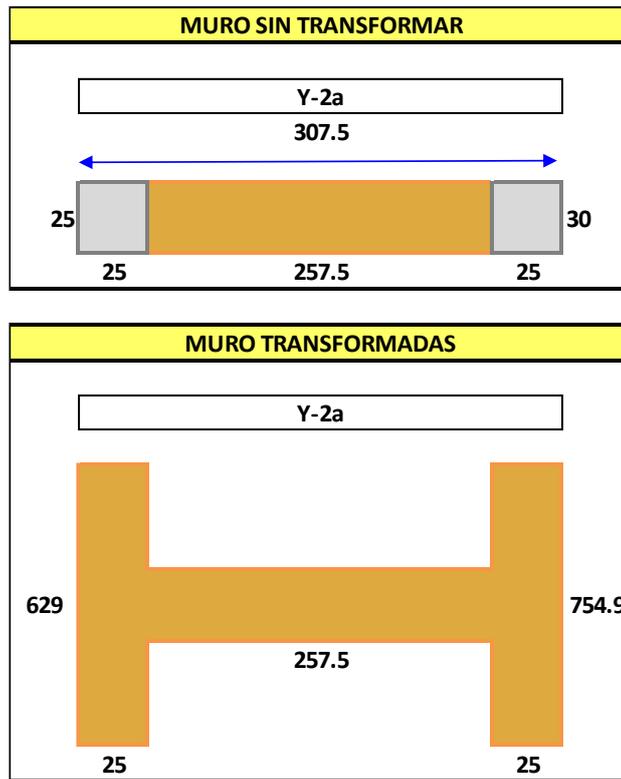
Fig. 68. Sección transformada muro Y-2b.
